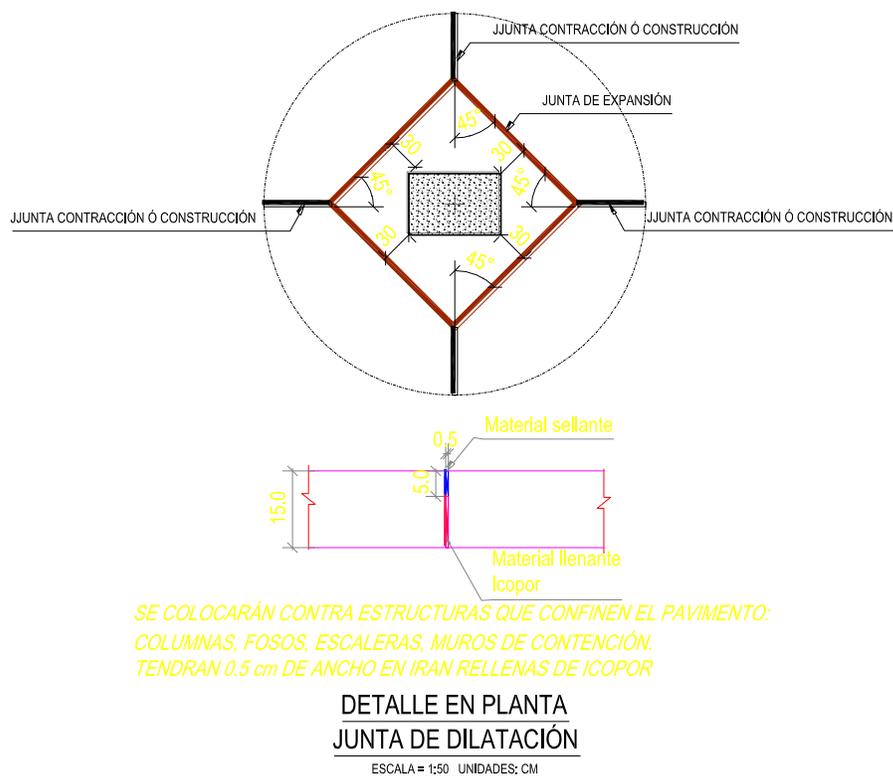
Detalle junta de dilatación. (Fuente: Departamento de diseño Metálicas e ingeniería S.A.)
